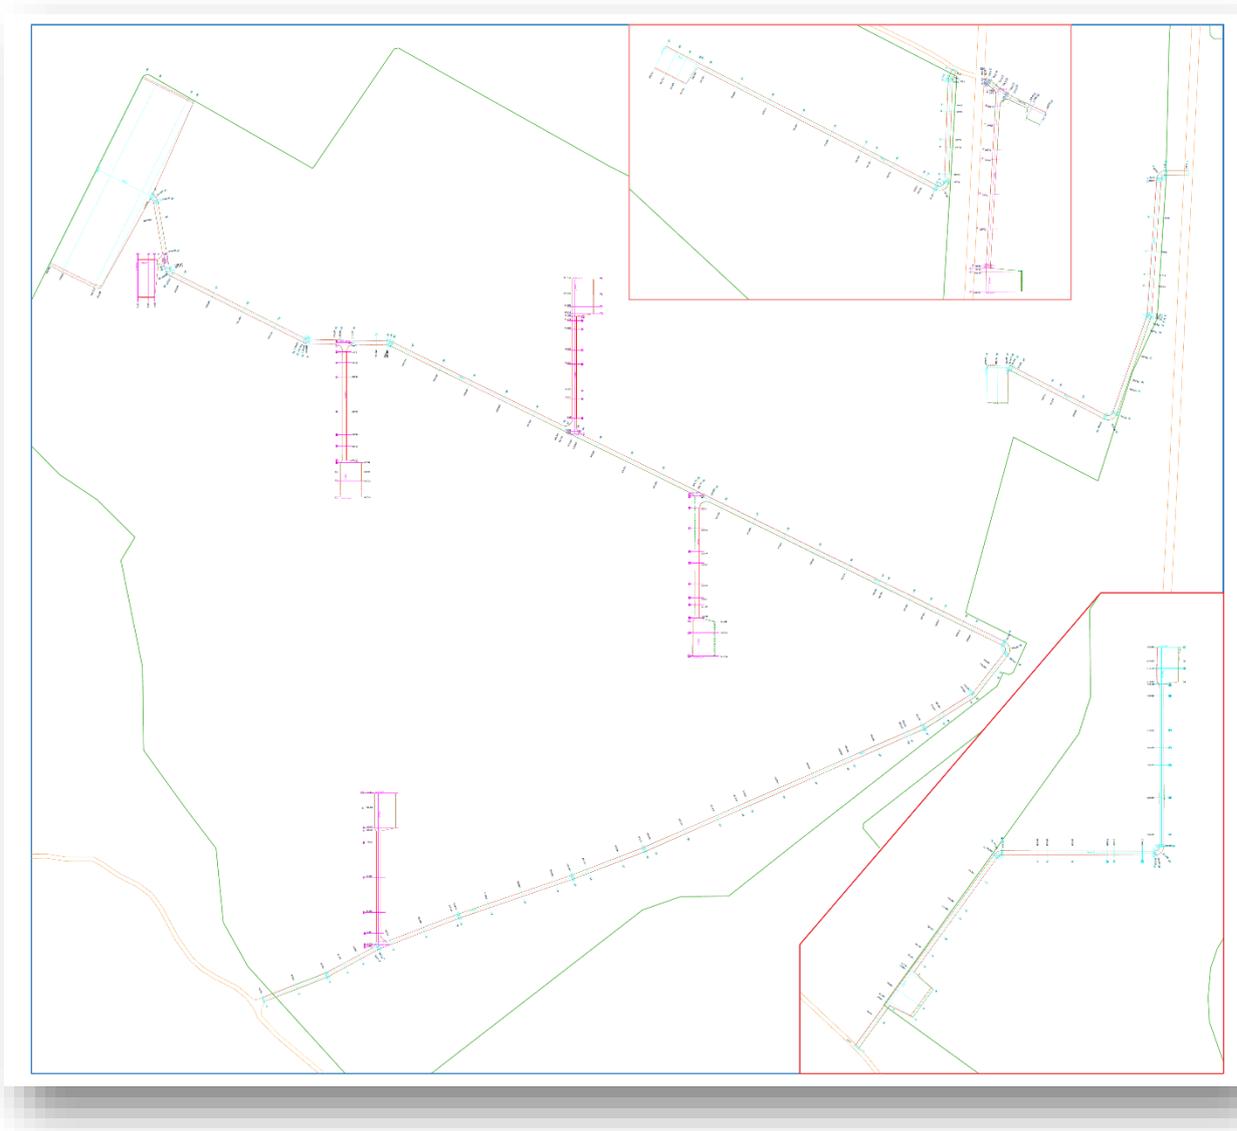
Estratto della tavola Planimetria Viabilità interna al parco
